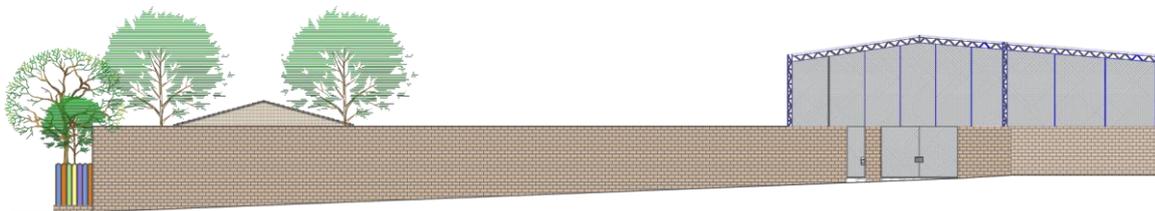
Elevação 2 – Lateral direita (Fonte: Produção do autor).
